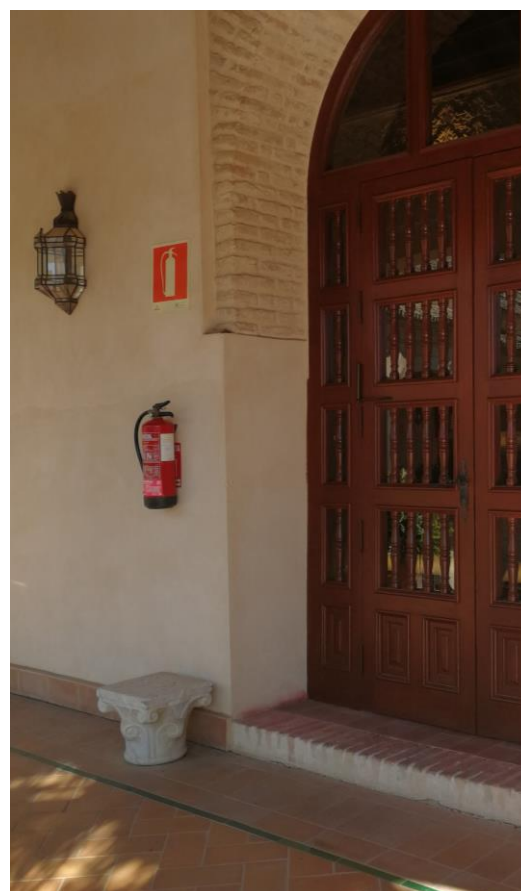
Extintor portátil en la puerta de acceso a museo de arte mudéjar. Fuente: EP.
